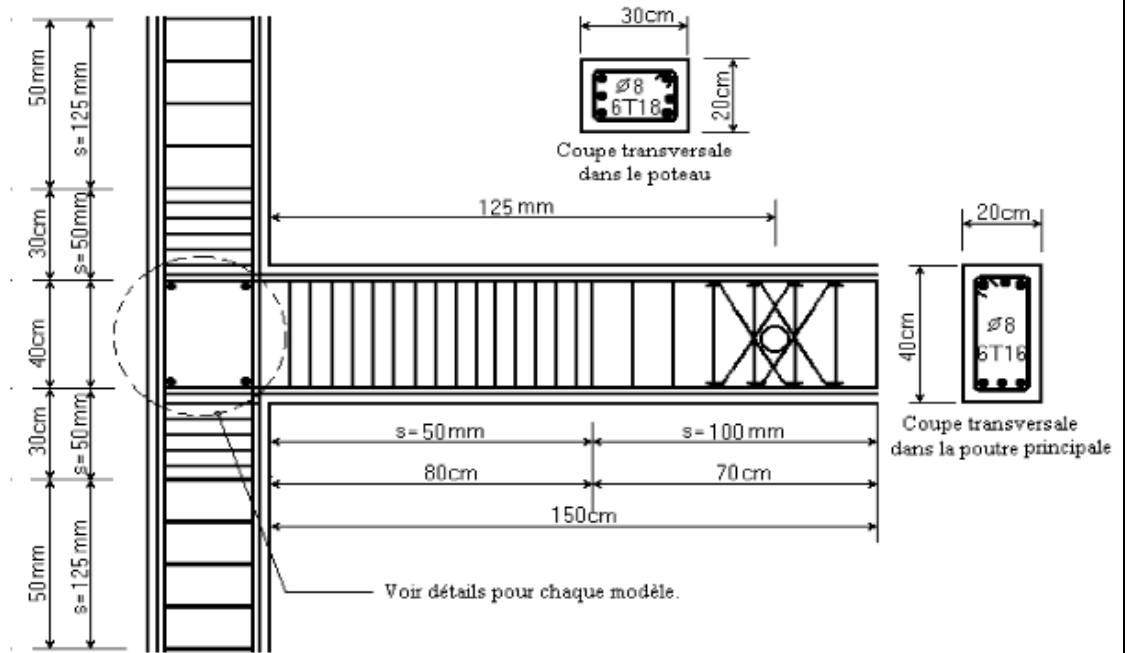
ferrailage de la poutre et du poteau principal.
